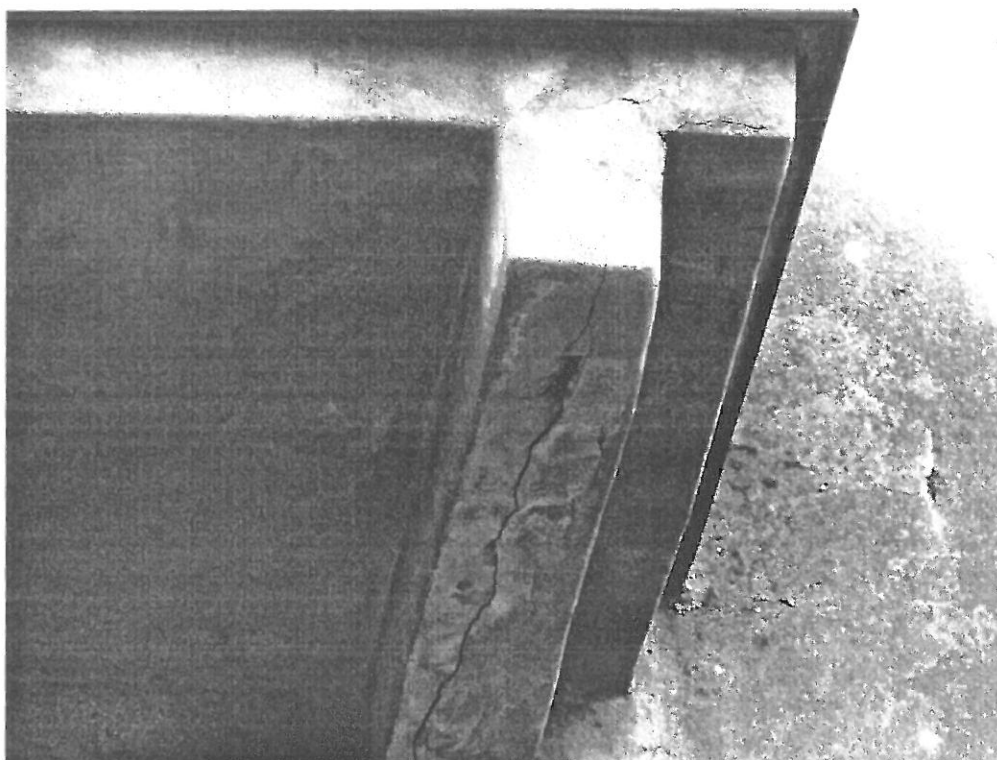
Widok więźbę dachową – widoczne miejsca uszczelniania pokrycia dachu zaprawą cementowo – wapienną z dodatkiem kleju .
